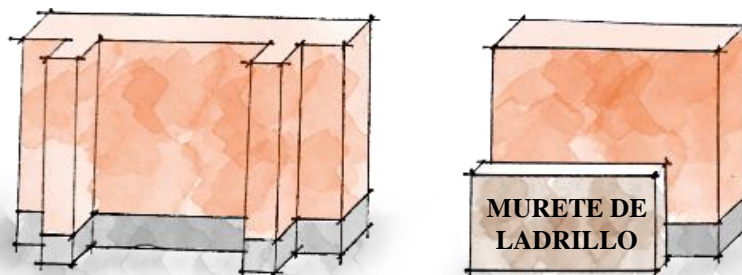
Muro de adobe, izq. Murete de ladrillo, der. Fuente: elaboración propia.
